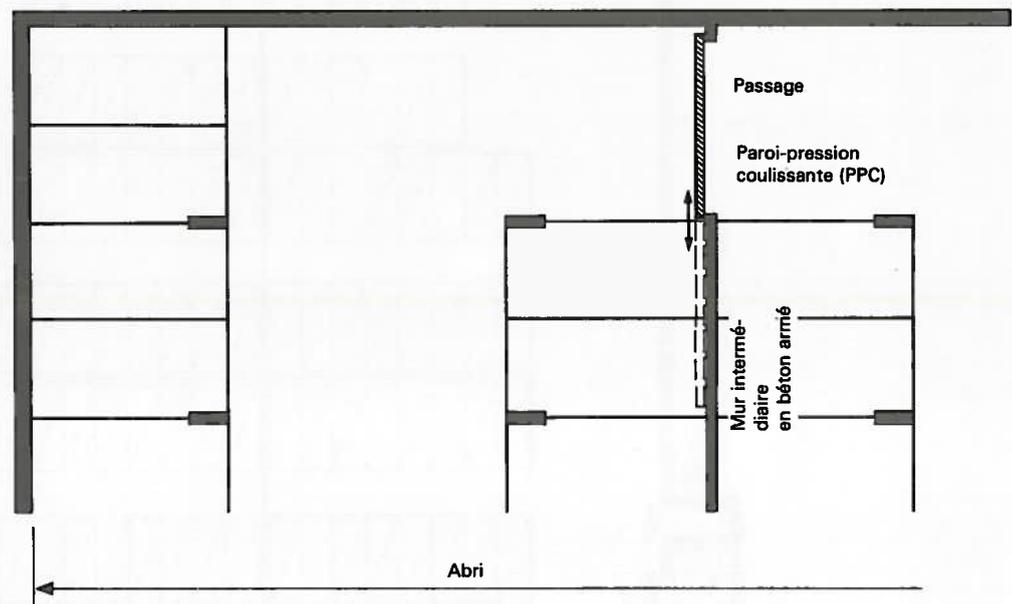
Exemple de disposition d'une paroi-pression coulissante (plan)
